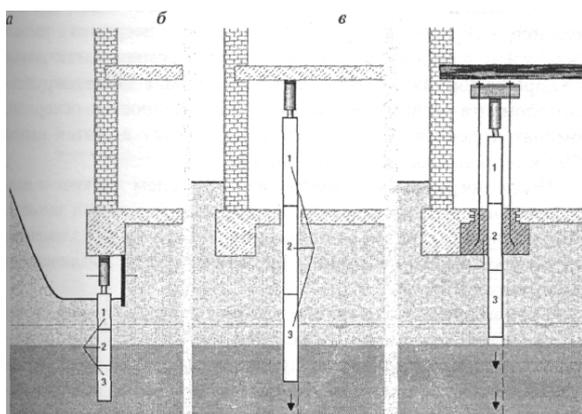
Варианты усиления фундаментов сваями вдавливания «Мега»: а — за счет упора домкрата в перекрытие подвала; б - за счет упора домкрата в усиливаемый фундамент; в — за счет анкерки вдавливающего механизма в монолитный «ростверк»; 1 - головной элемент; 2 - рядовой элемент; 3 - нижний элемент
